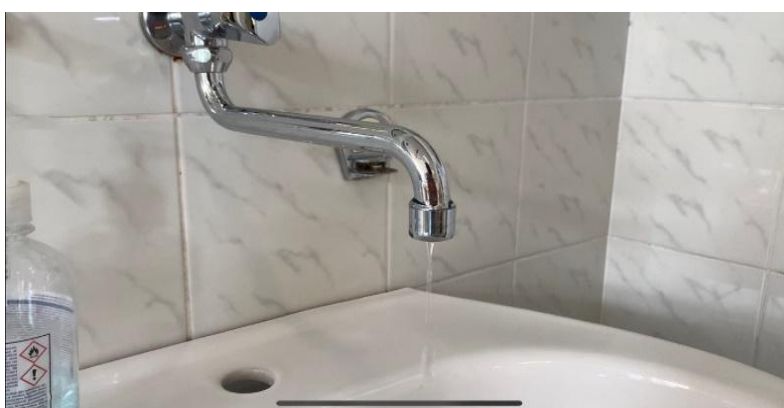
Šolski center Velenje, gimnazija, stavba A [29]
